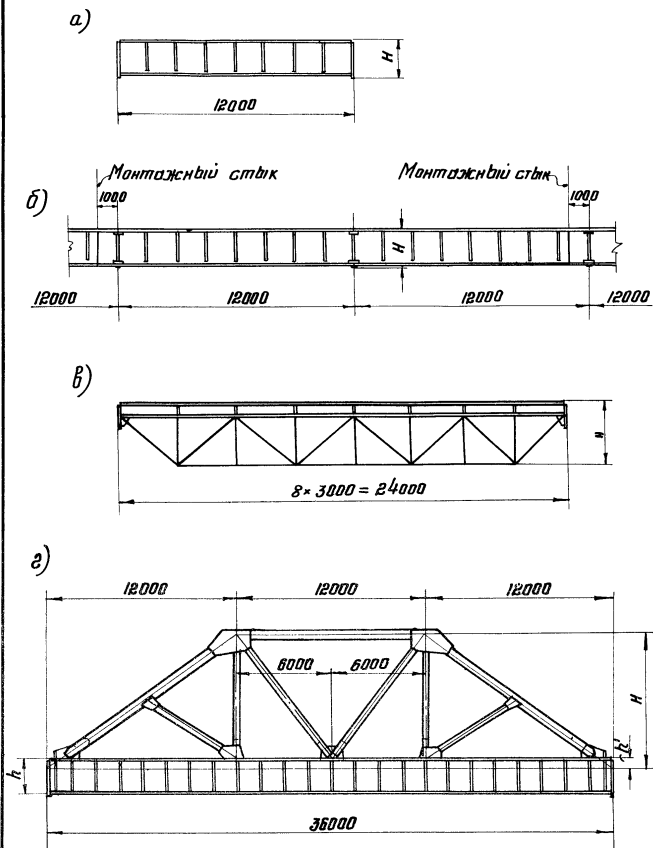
Конструкции сварных подкрановых балок:
